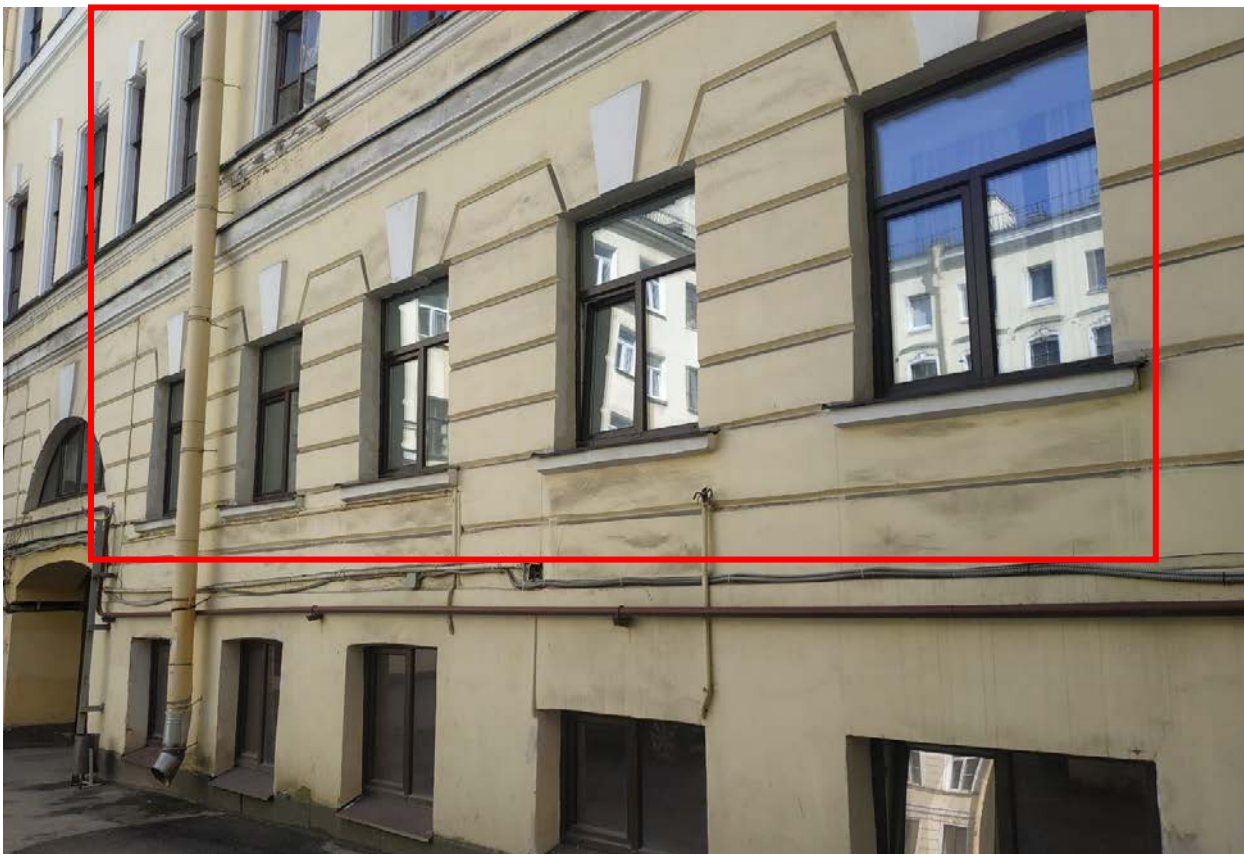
Фрагмент дворового фасада. Заполнения оконных проемов кв. №1.
